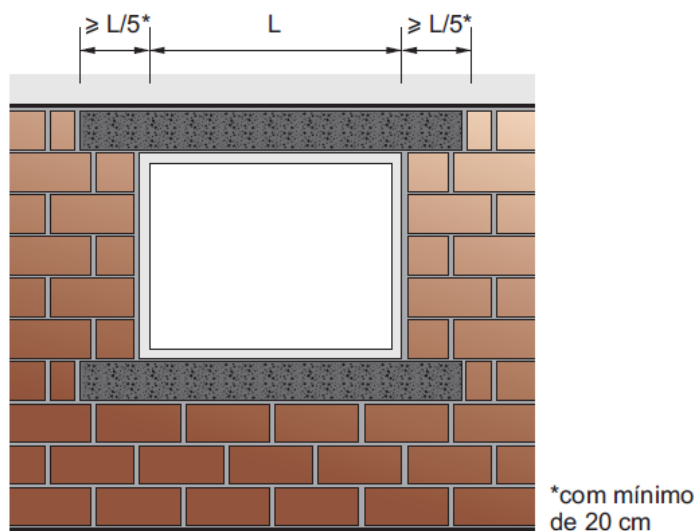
Verga e contraverga de concreto armado. Fonte: Thomaz et al. (2009).
